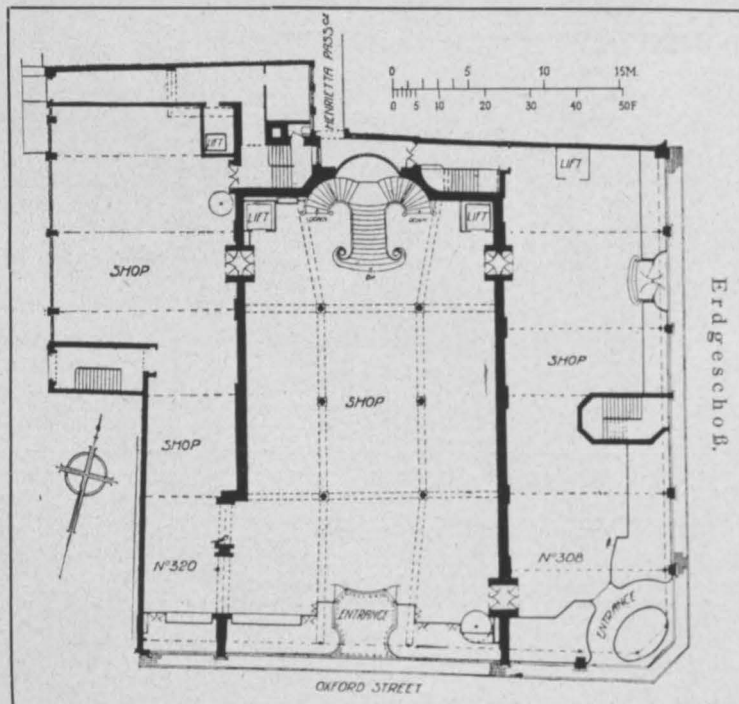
Evans-London. Architekt John Murray-London\*\*).
